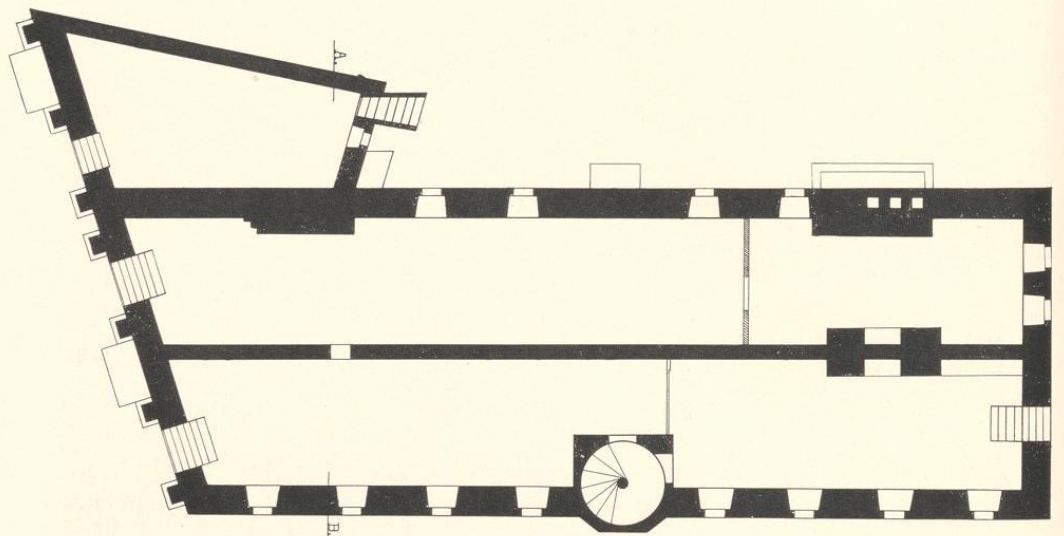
Grundriß des Kellergeschosses der Stadtlegge und des Stadtkellers. Norden oben; Maßstab 1 : 200
